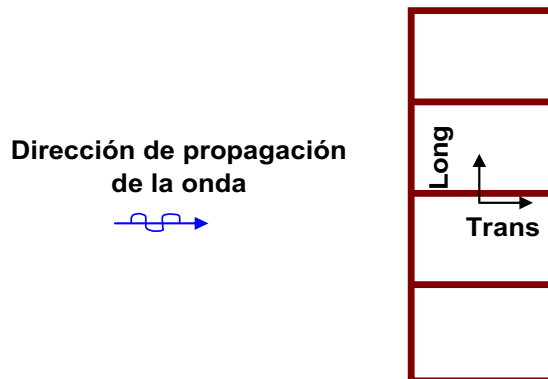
Vista en planta de la dirección más desfavorable de arribo de la onda Rayleigh para la estructura.
